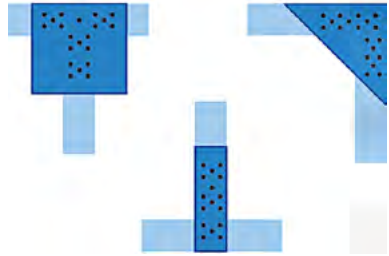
Schichtholzplatten zum Fixieren von Holzelementen (Blockhaus, THW)
